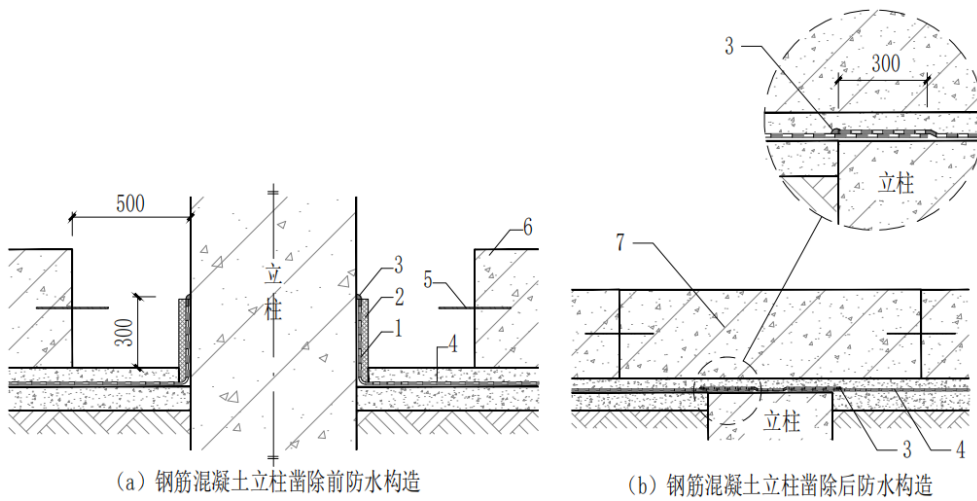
钢筋混凝土立柱与底板节点构造
